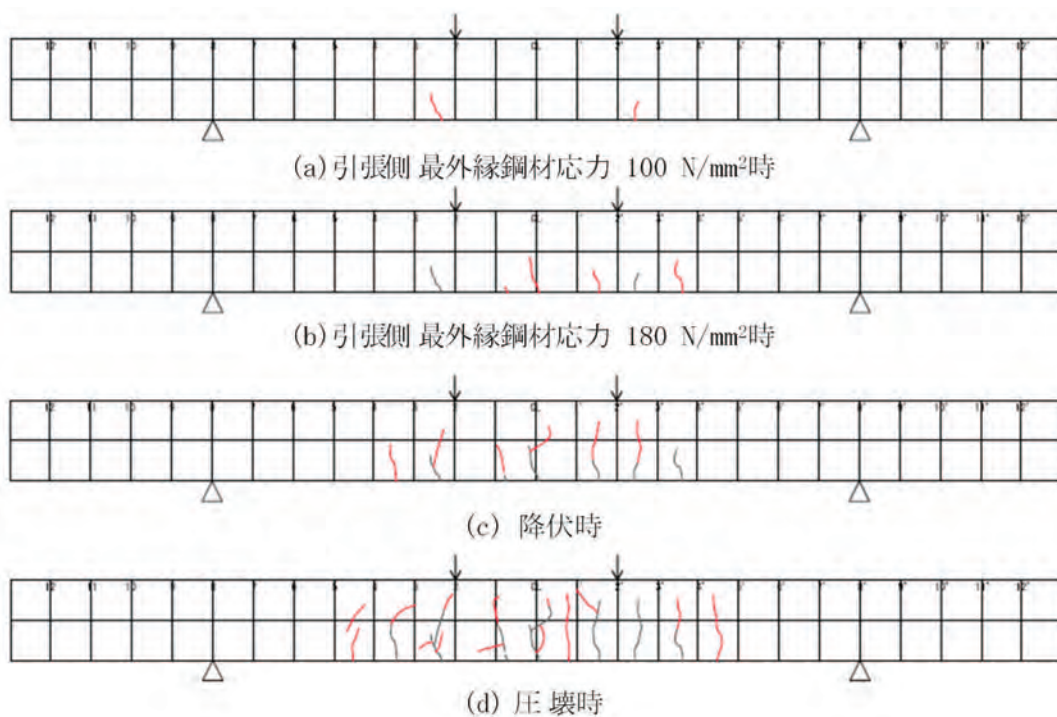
載荷に伴うひび割れの進展状況 (試験体 2a, 2b)
